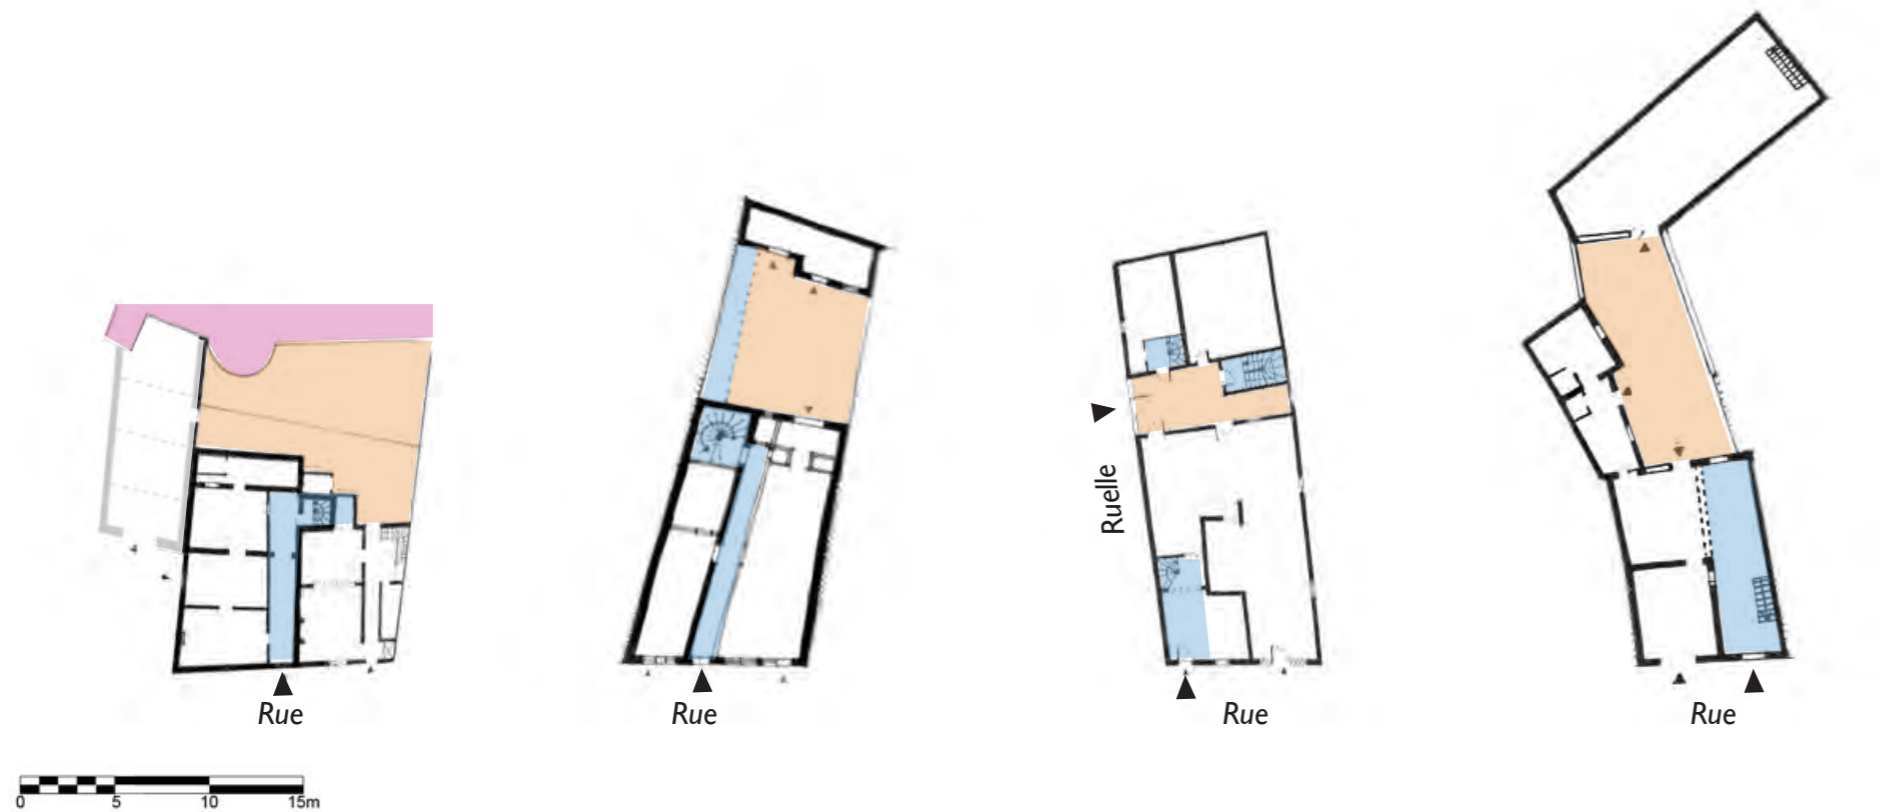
Plans rez-de-chaussée des maisons commerçantes et de faubourg
